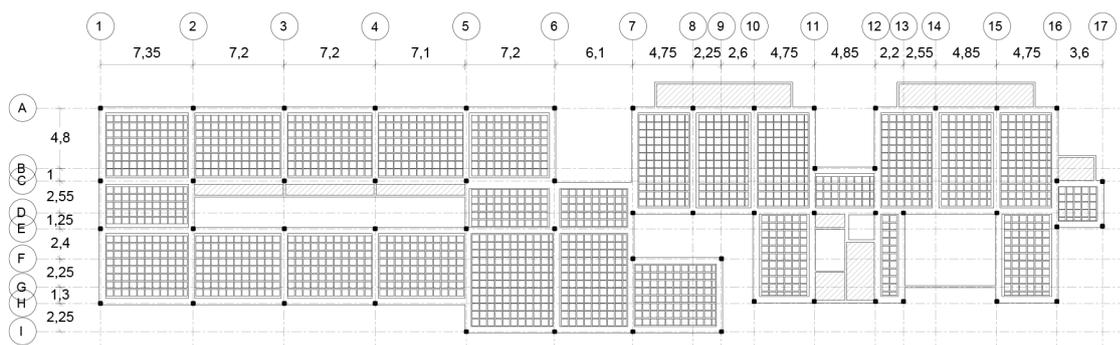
Planta de Estrutura da laje de piso do 1º pavimento.
